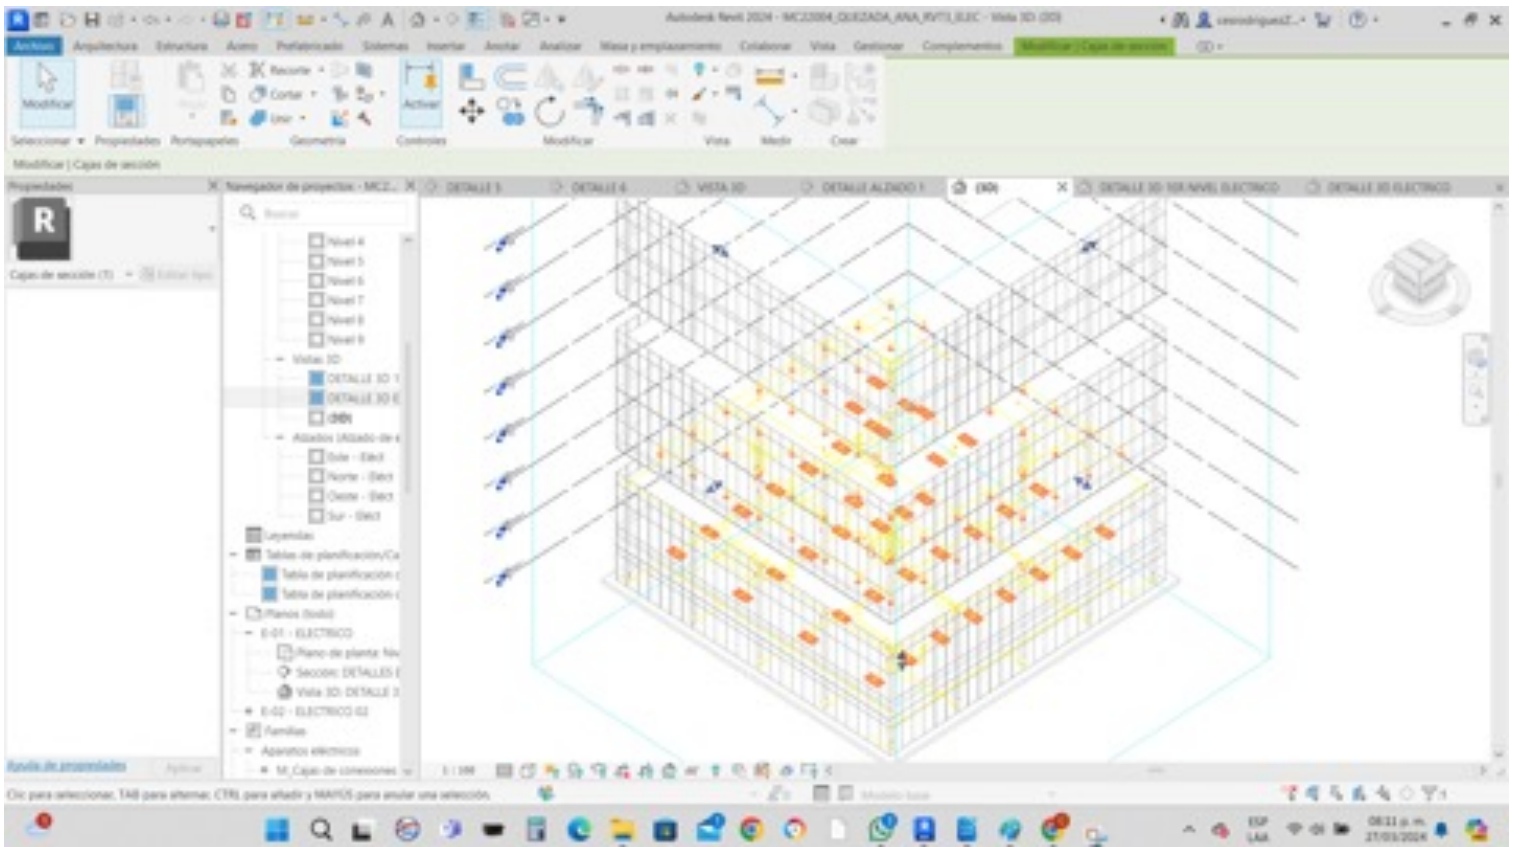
Vista 3D general del proyecto eléctrico de la alumna Ana Belén Quezada López de la materia Revit III de la maestría en construcción del ITC
